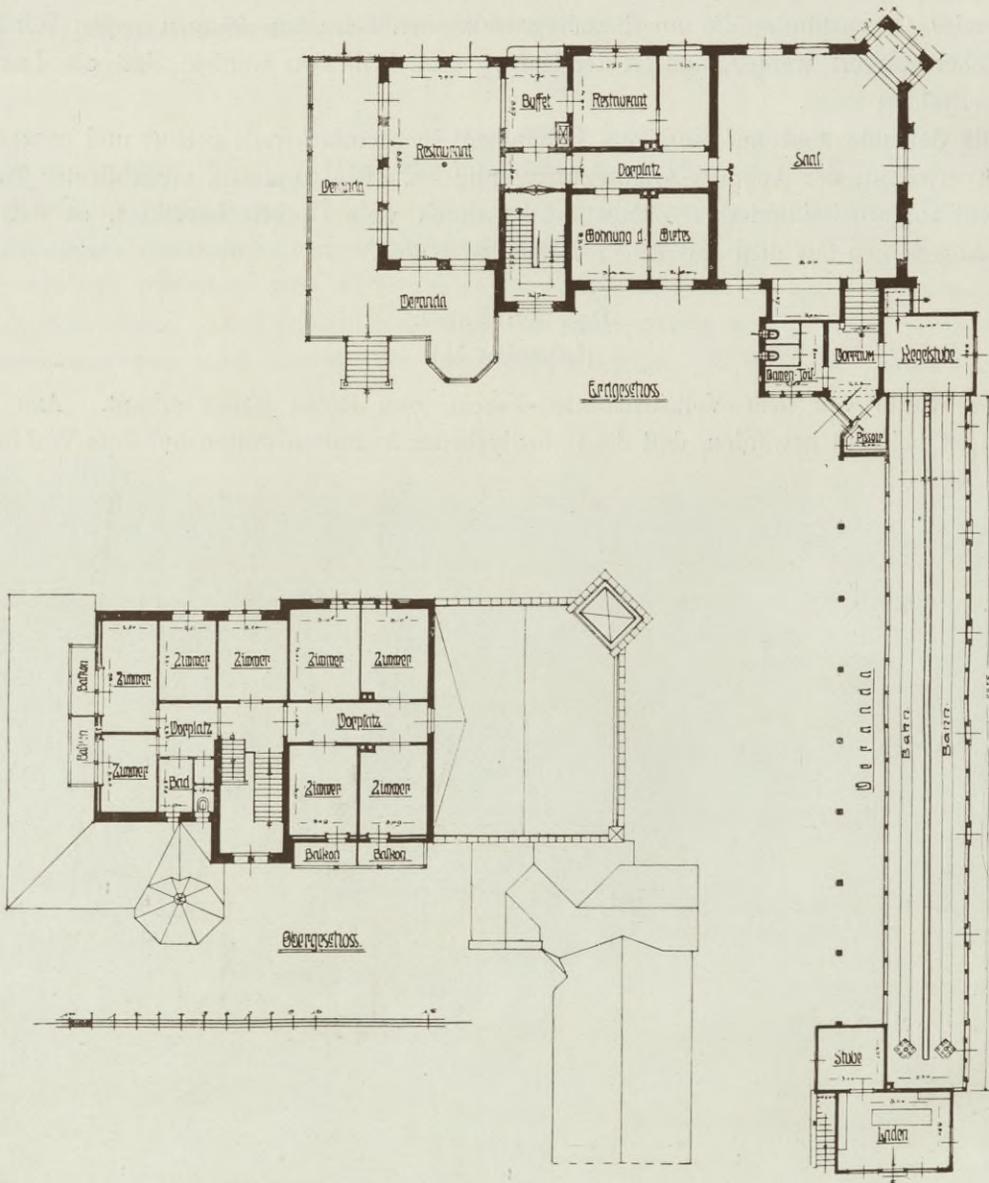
und 61. Kurhotel Hohenlychen. Grundrisse.
